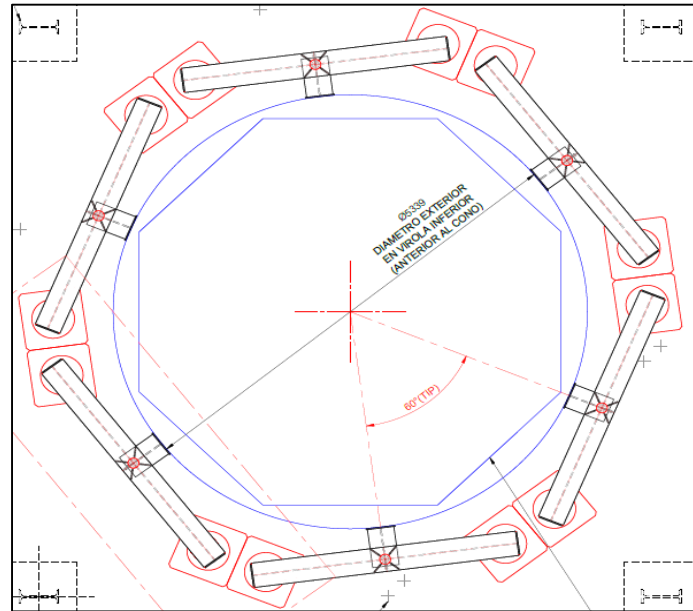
Esquema en planta de la distribución de elementos de elevación
